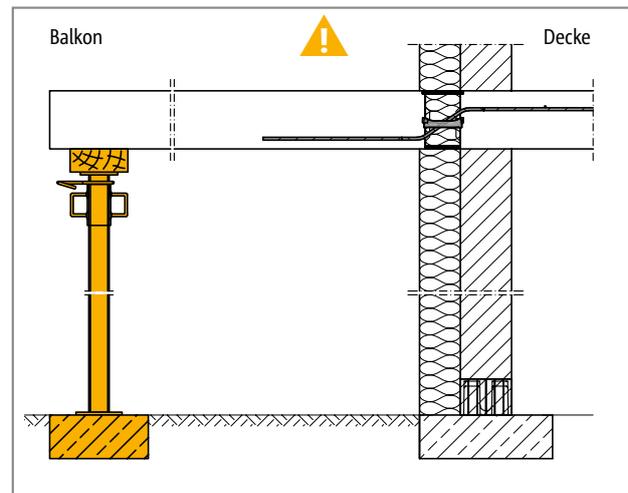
Schöck Isokorb® XT Typ QL: Stützung durchgängig erforderlich
